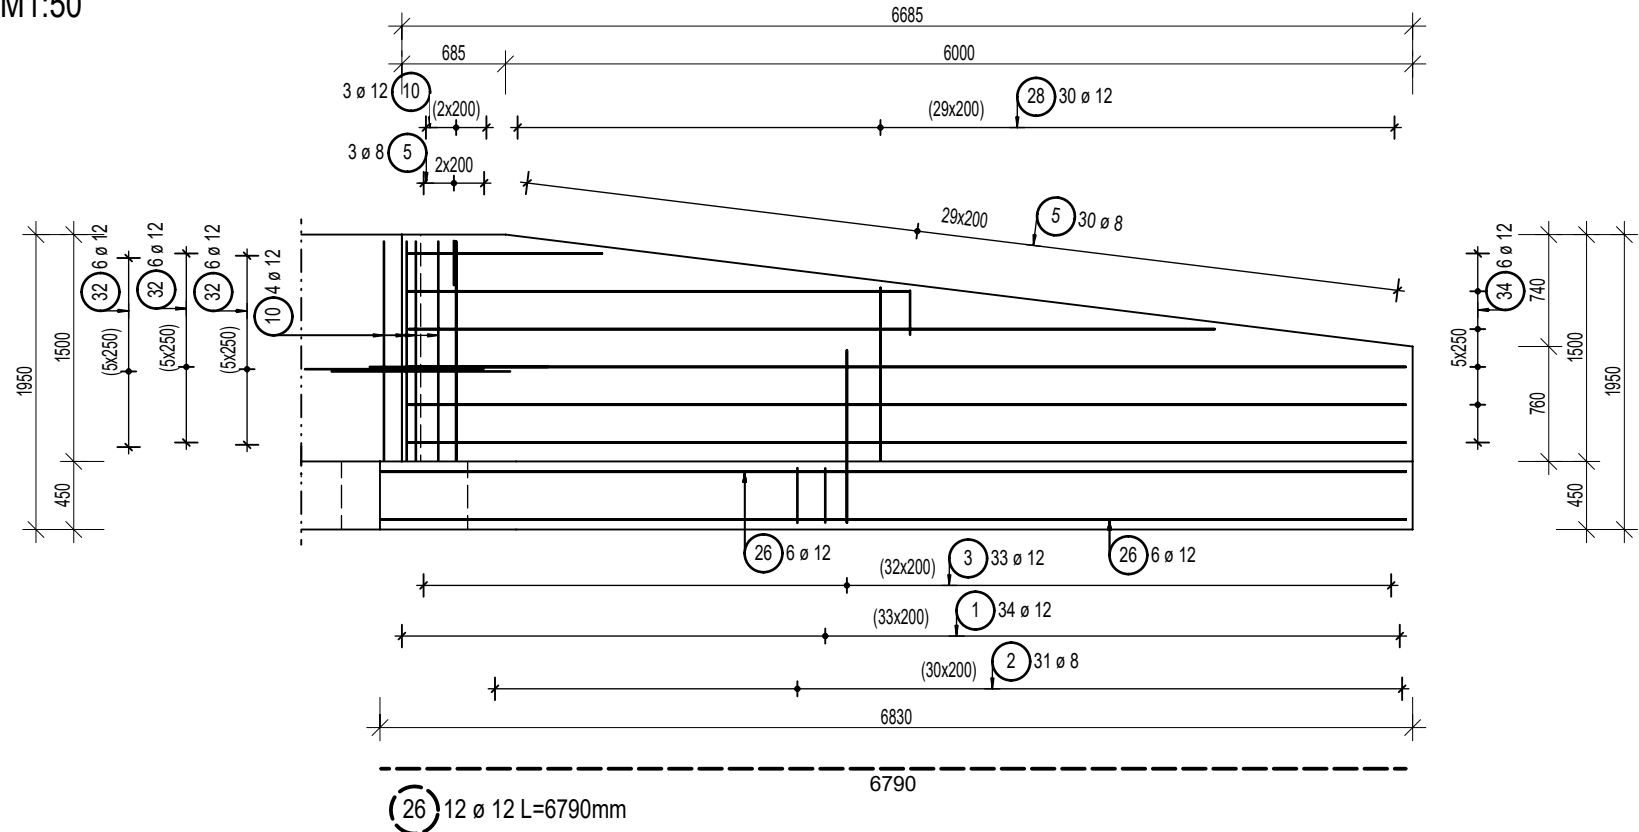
DETAIL VYZTUŽENÍ ŠIKMÝCH ROHŮ
